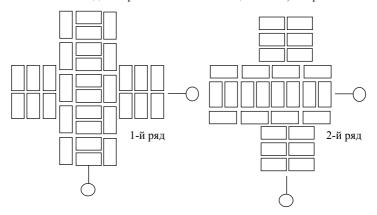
Кладка пересечений стен толщиной в 2 кирпича
